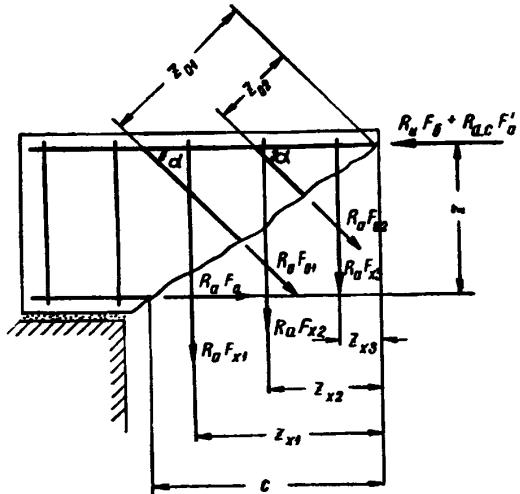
Схема усилий, действующих в наклонном сечении изгибающегося железобетонного элемента, при расчете его на прочность
